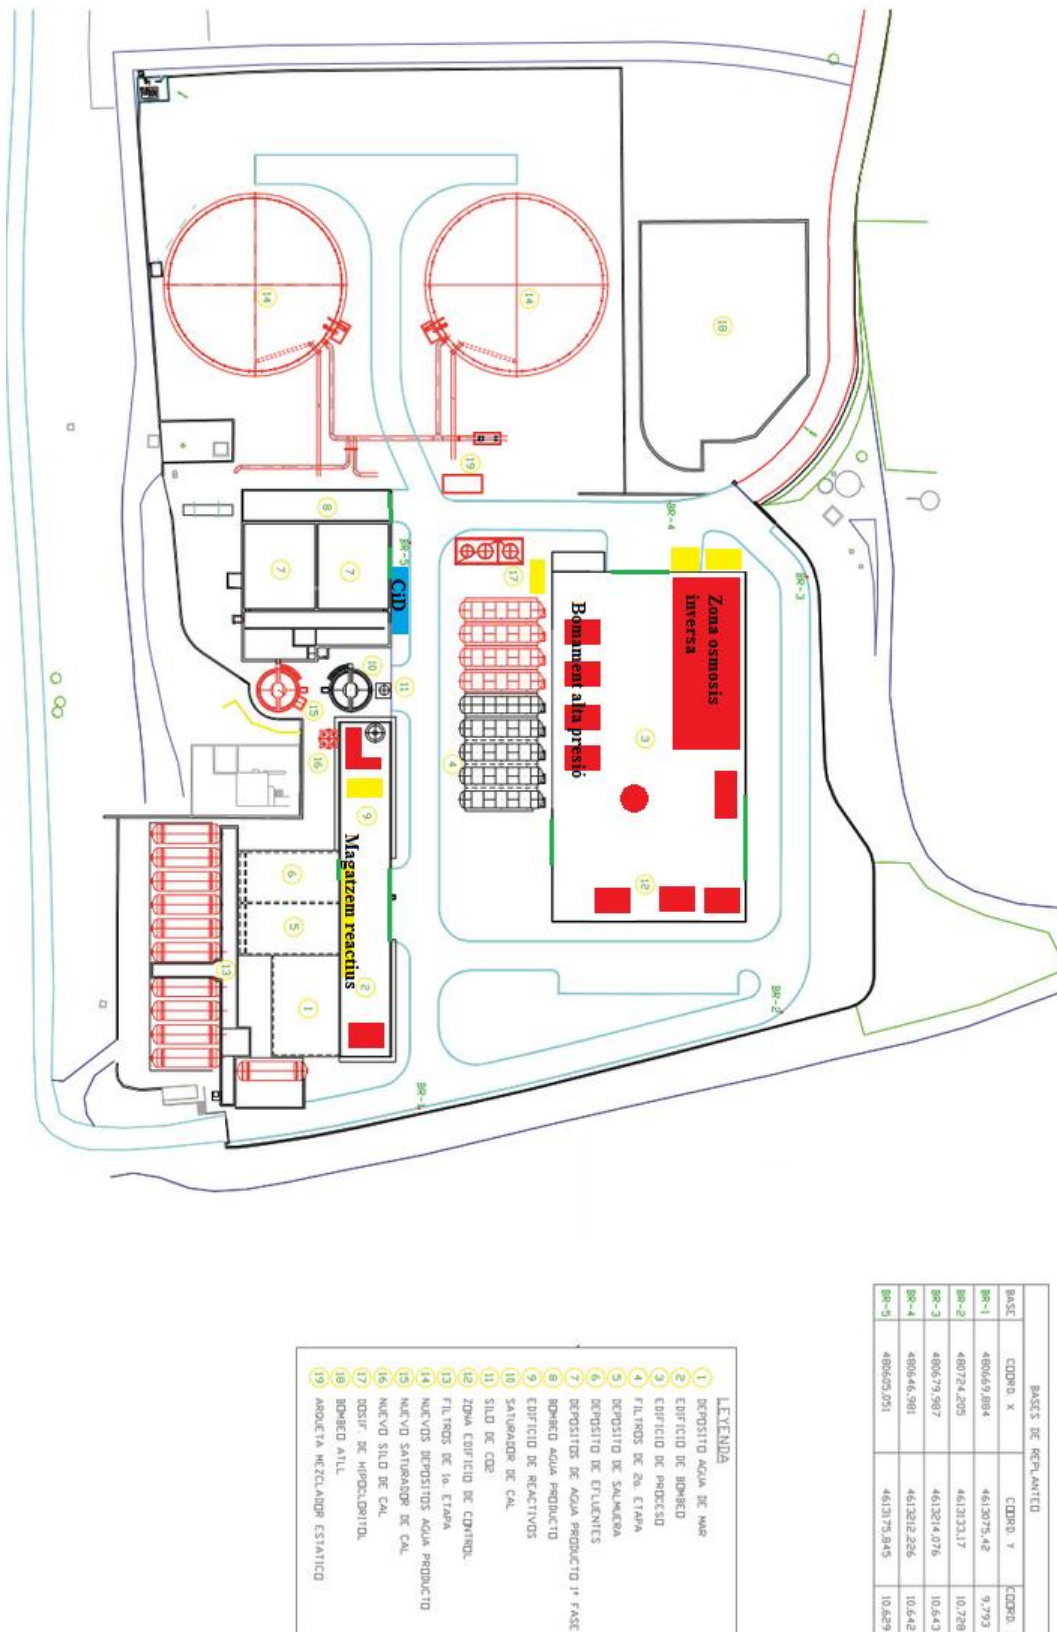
Layout a escala del interior de la planta amb les zones més importants.
